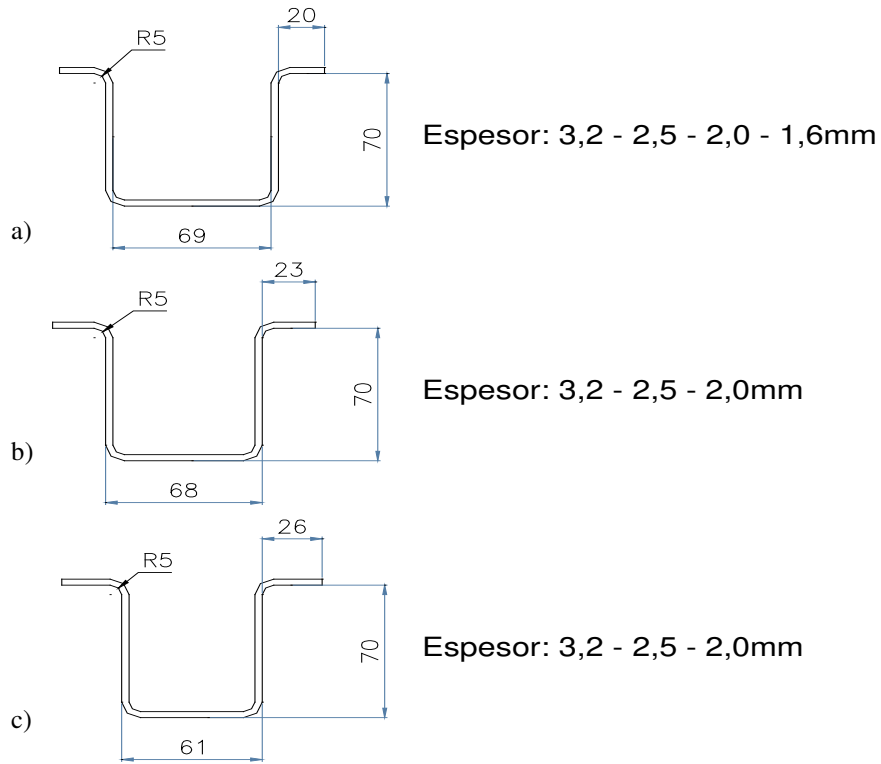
Sección transversal de las columnas: a) *Sección 1*, b) *Sección 2*, c) *Sección 3
